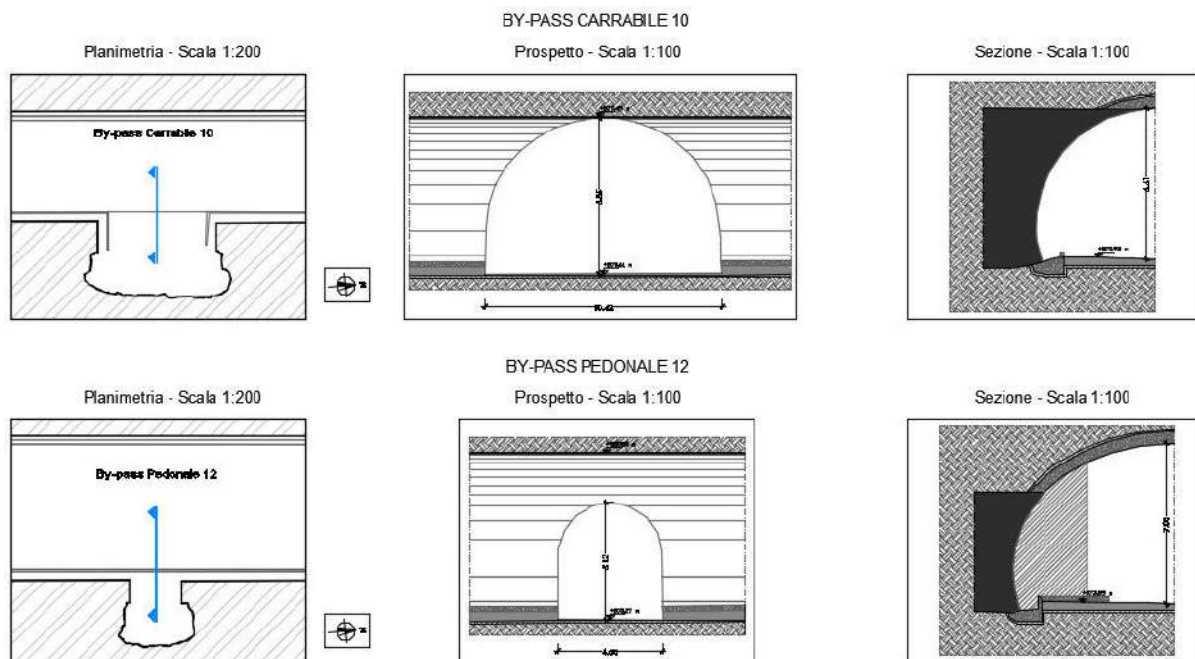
Planimetrie, Prospetti e Sezioni by pass– esempio di restituzione grafica.
